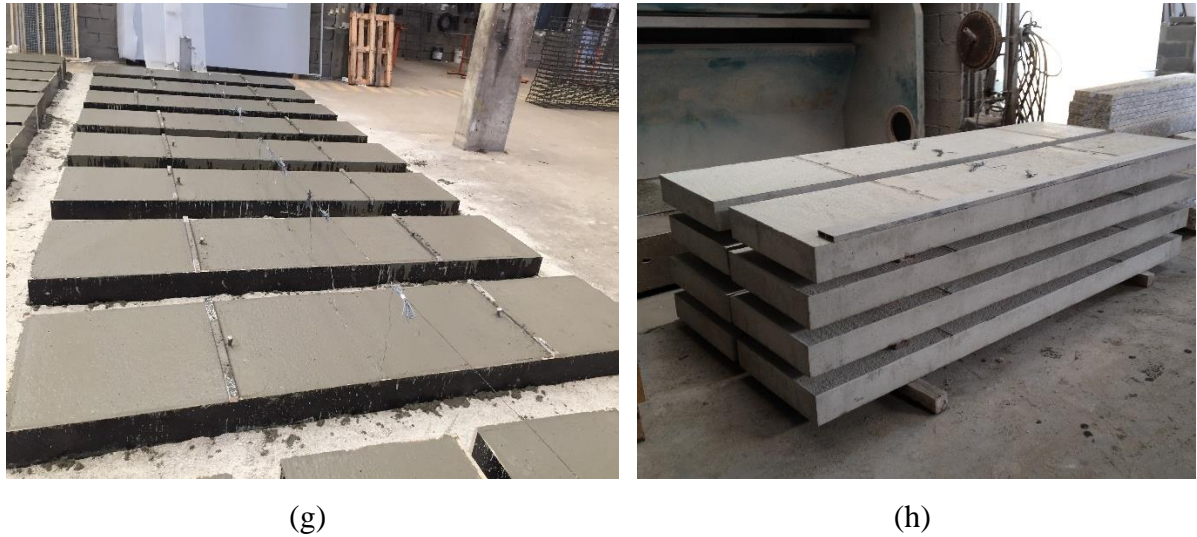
(cont.) - Processo de betonagem das faixas de laje: (a) produção das armaduras para as faixas de laje; (b) aplicação de extensómetros nas armaduras; (c) preparação das cofragens, aplicação do óleo descofrante e colocação das armaduras; (d), (e), (f) e (g) betonagem; (h) provetes curados após descofragem.
